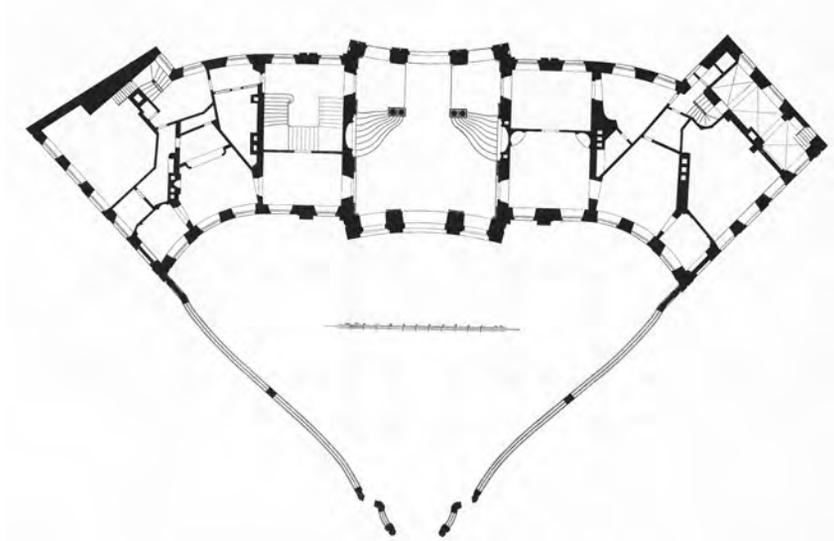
Münster, Erbdrostenhof, Salzstraße, Grundriss des Erdgeschosses
